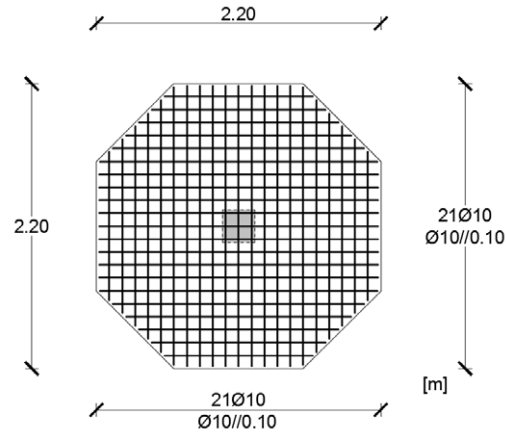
Distribuição de armaduras inferiores lajes hexagonais (adaptado de [8])
